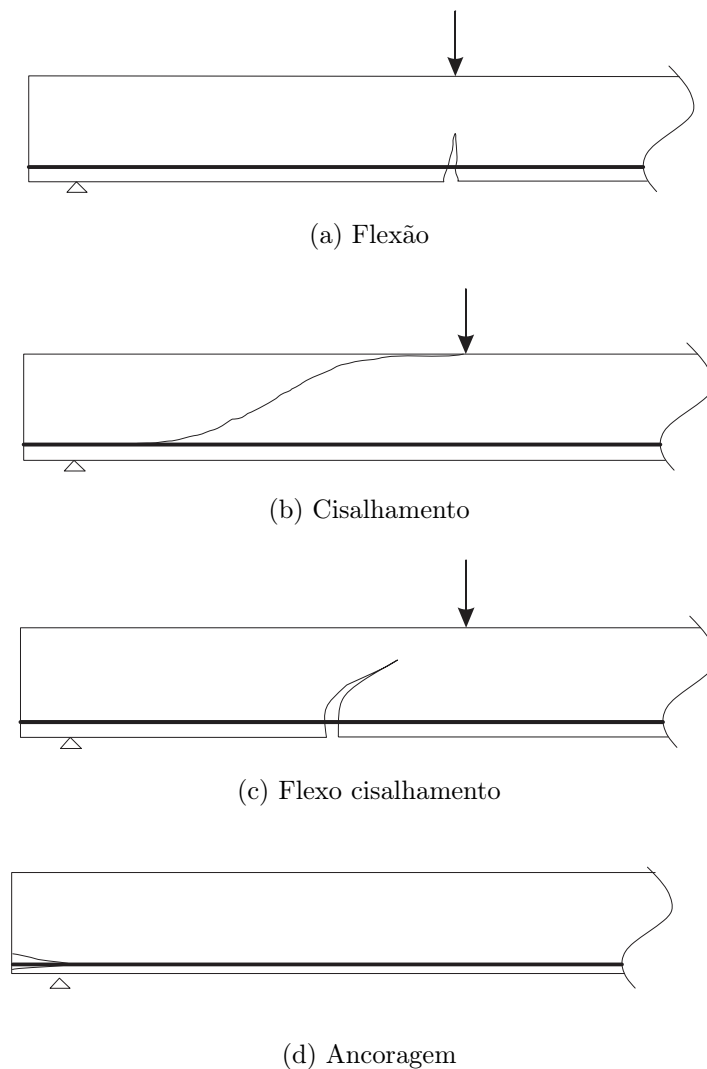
Padrão de fissuração característico para os modos de falha em vigas de concreto armada e protendido
